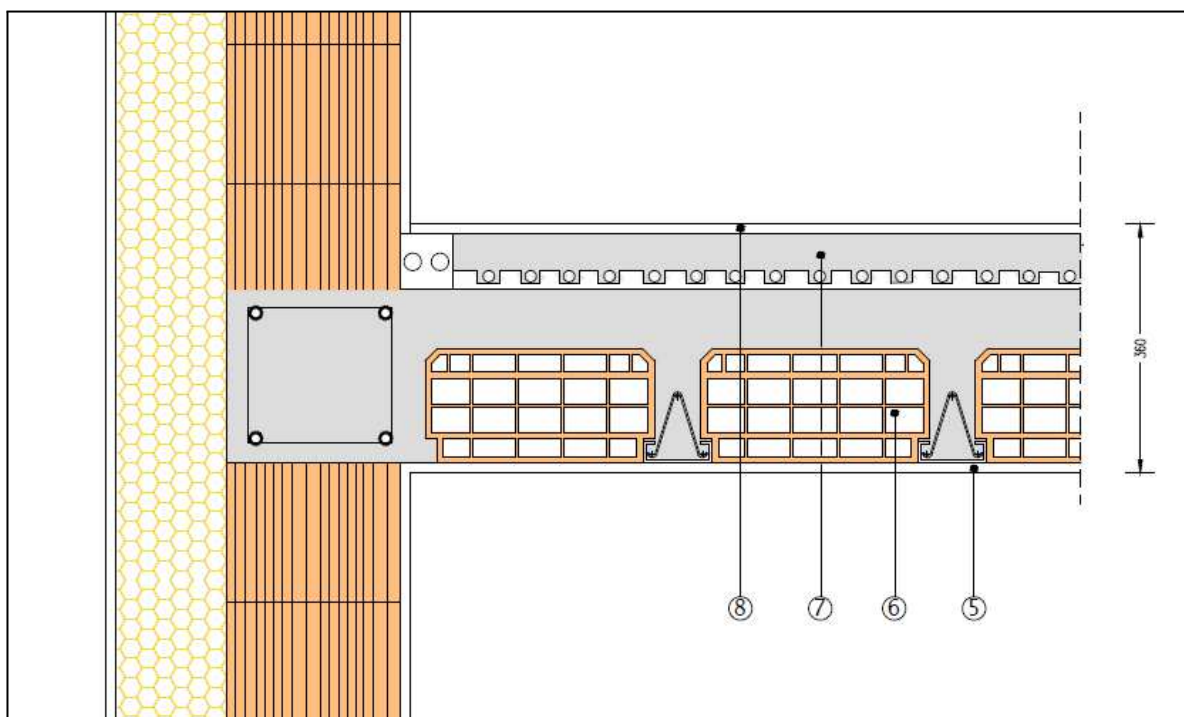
Sistema a telaio in C.A. nodo parete perimetrale-solaio interpiano
